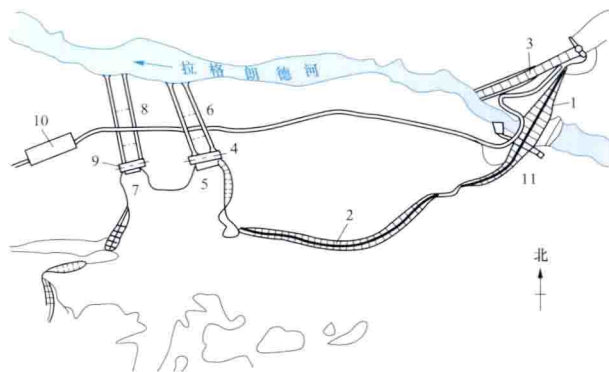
罗伯特-伯拉萨水电站枢纽平面布置图
